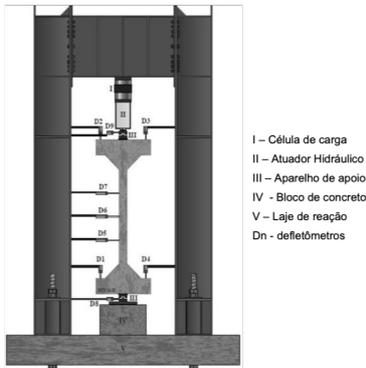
Pilar posicionado no pórtico de reação com a instrumentação
